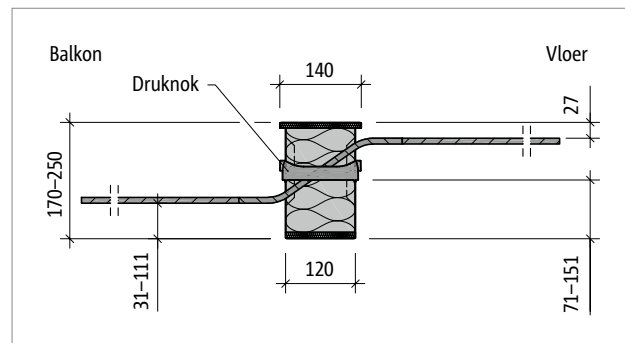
Schöck Isokorf® XT type Q-E-V6: Doorsnede
